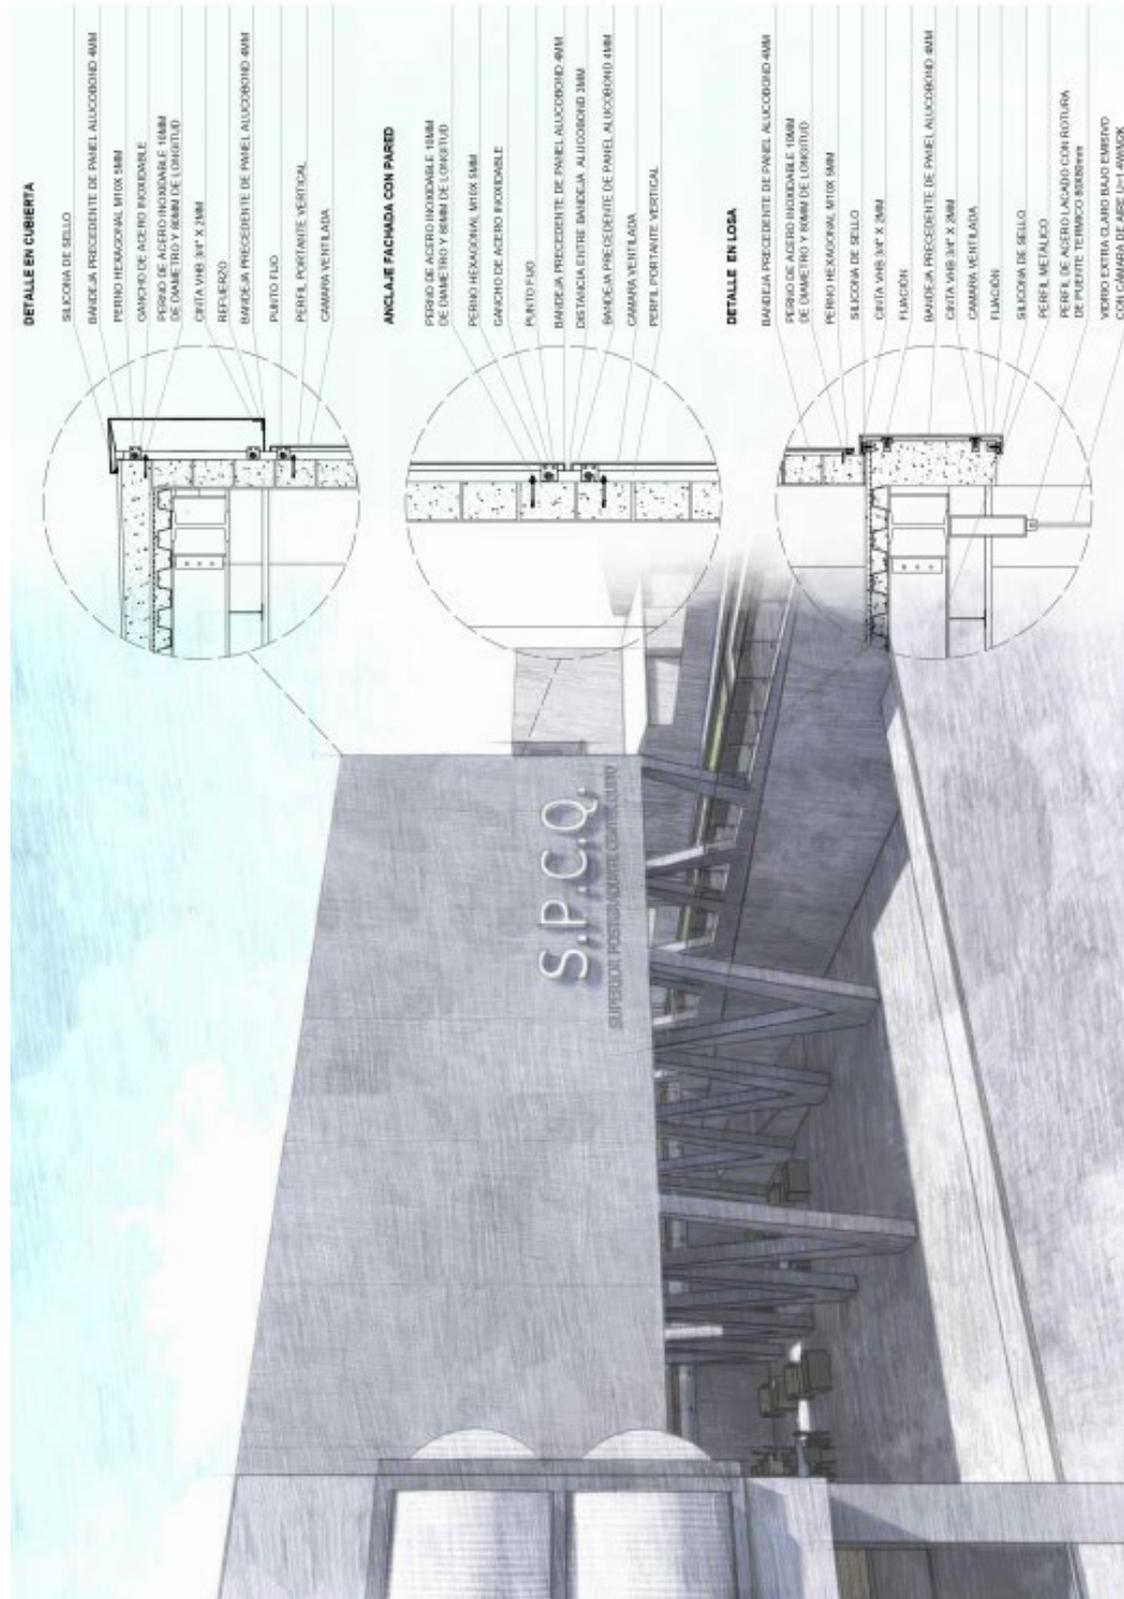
Detalle constructivo ALUCOBOND. Elaboración propia.
